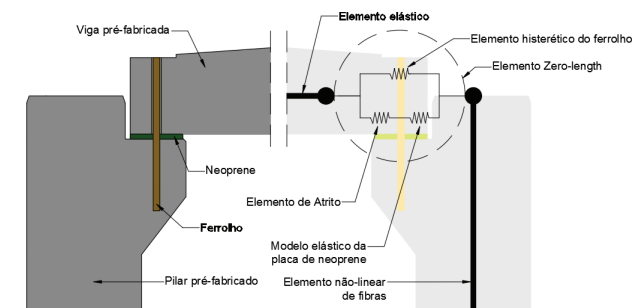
Ligação viga-pilar em edifícios prefabricados de betão armado: configuração típica (esquerda) e esquema do modelo numérico adotado (direita)
